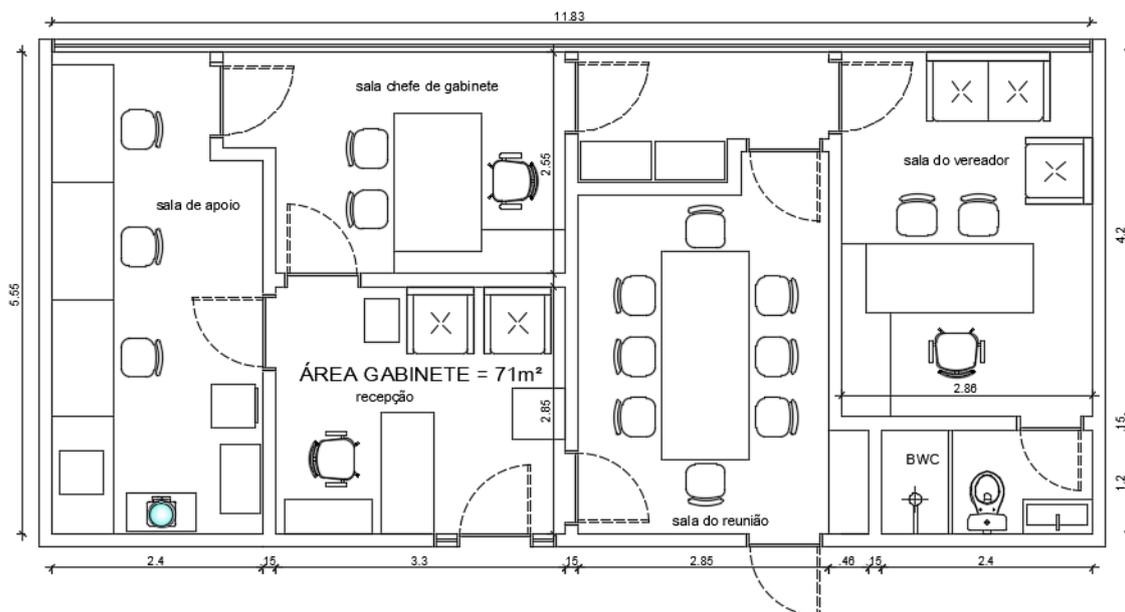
Planta baixa Gabinete de ALEPE, projeto Pontual Arquitetos.
